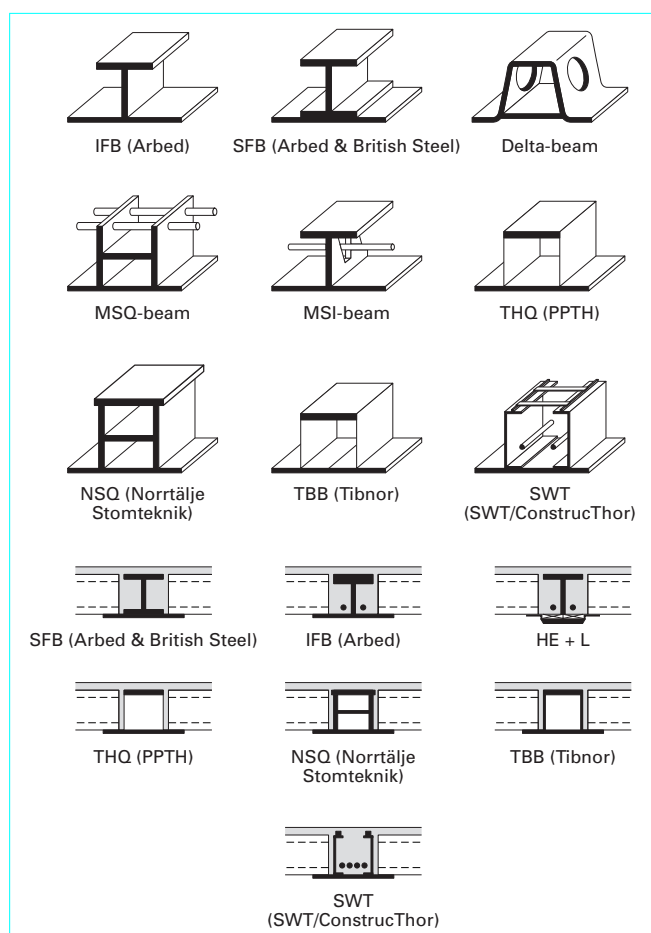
Plancher à poutrelles intégrées. Différentes formes de poutres
